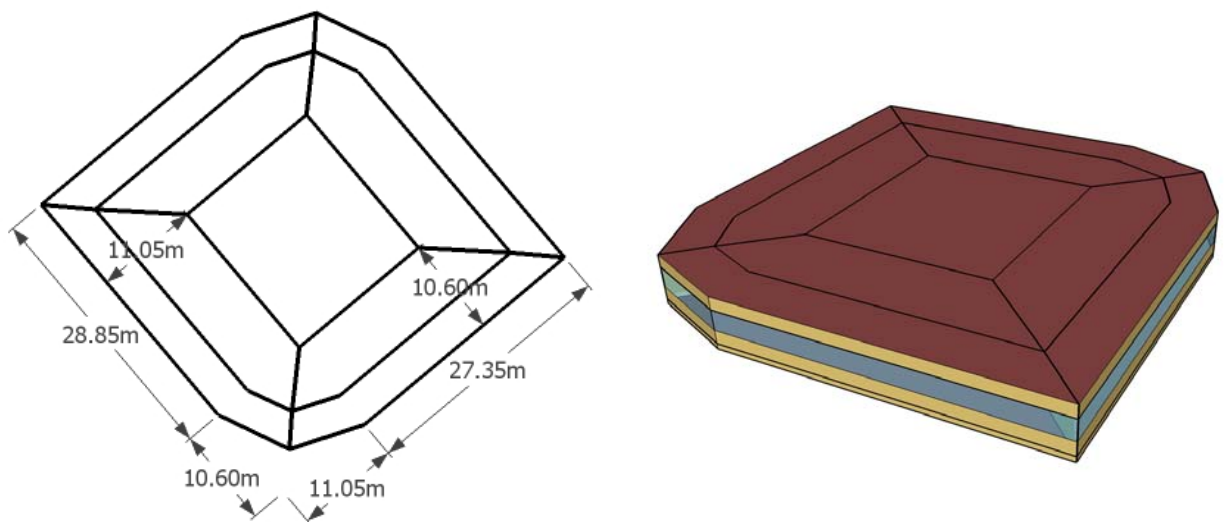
Planta e modelo espacial do Proposed Building para o estudo de caso #8
